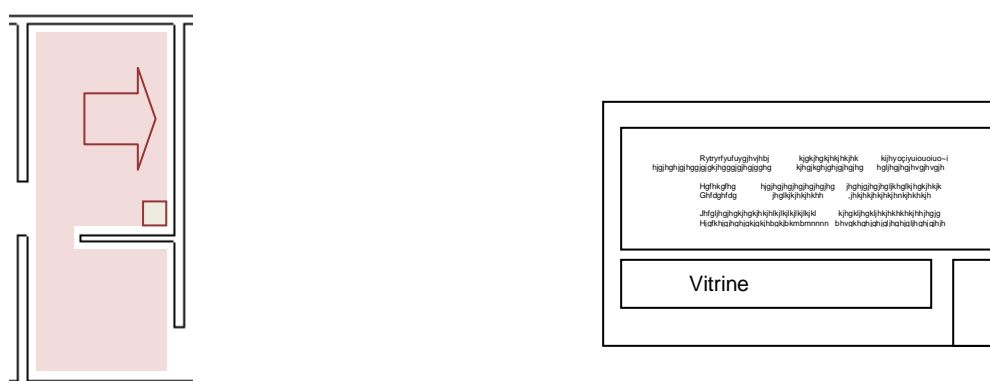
Módulo Edificações. Planta baixa e elevação esquemática da parede 03.
